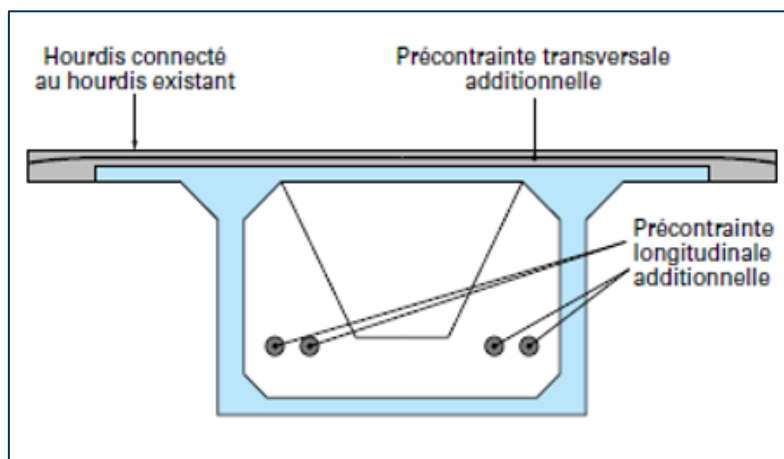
Elargissement de la dalle de couverture d'une poutre-caisson
